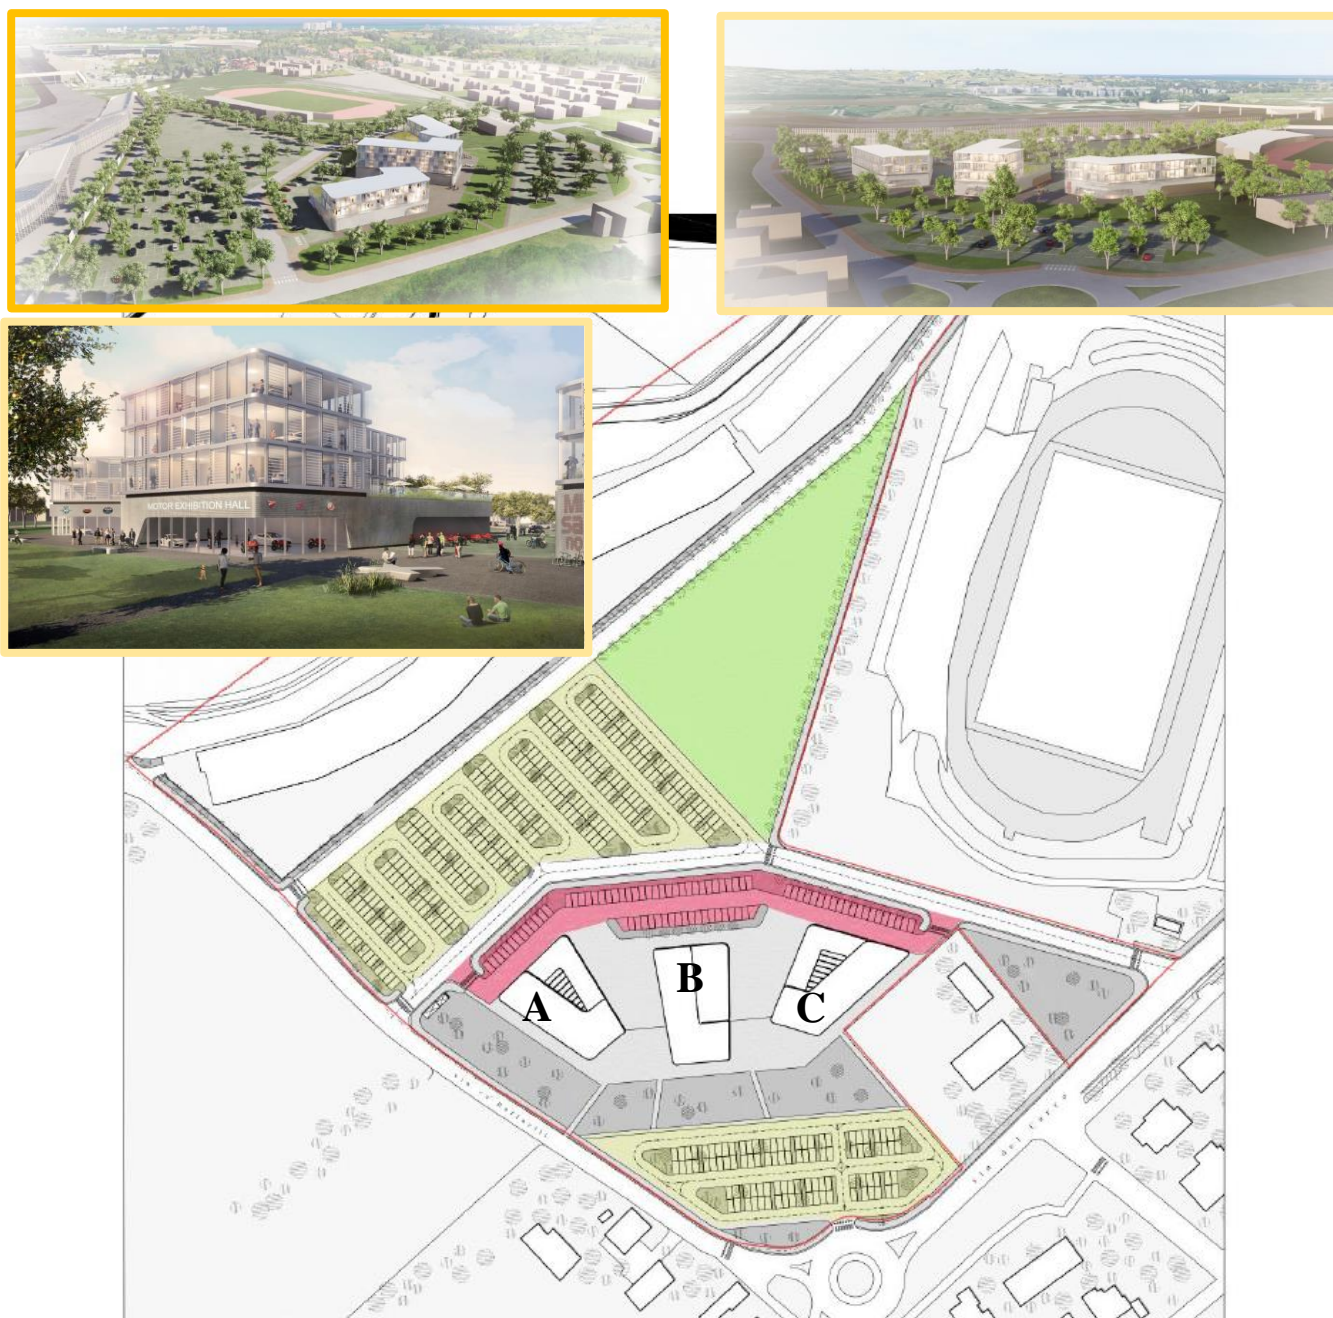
Planivolumetrico del progetto del Piano Particolareggiato in esame.
